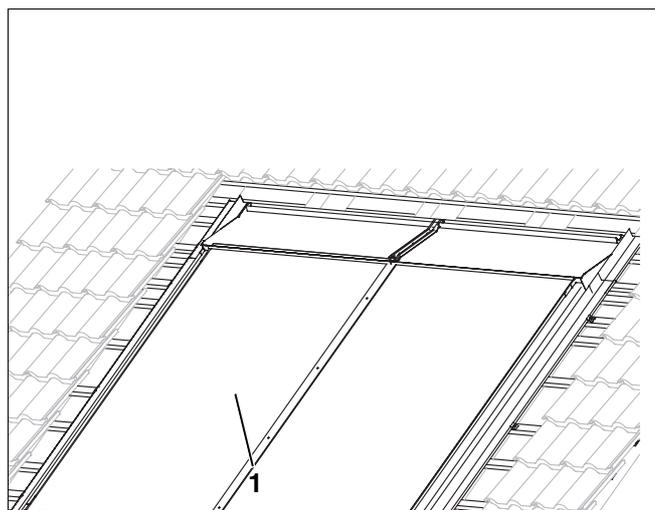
Lamiere di copertura montate su tutto il perimetro
